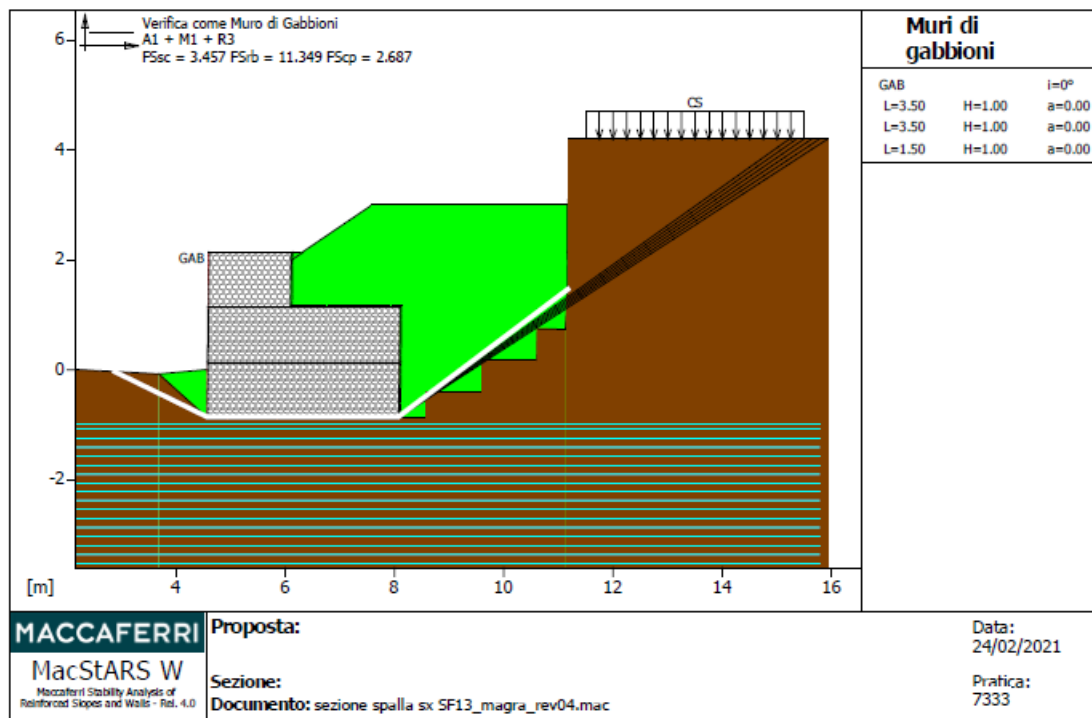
Verifica come muro di sostegno sezione spalla sx- condizione di magra -statica
